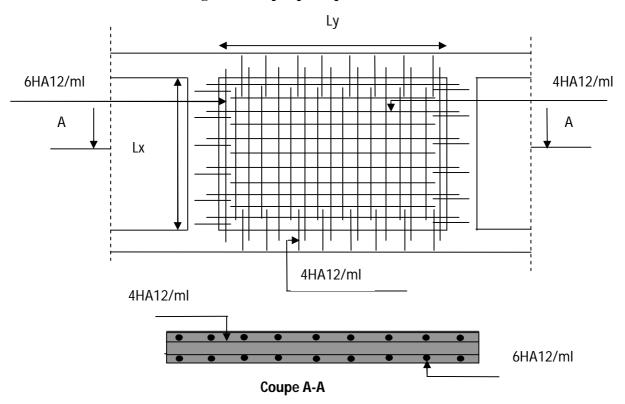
Schéma de ferraillage du voile périphérique :
